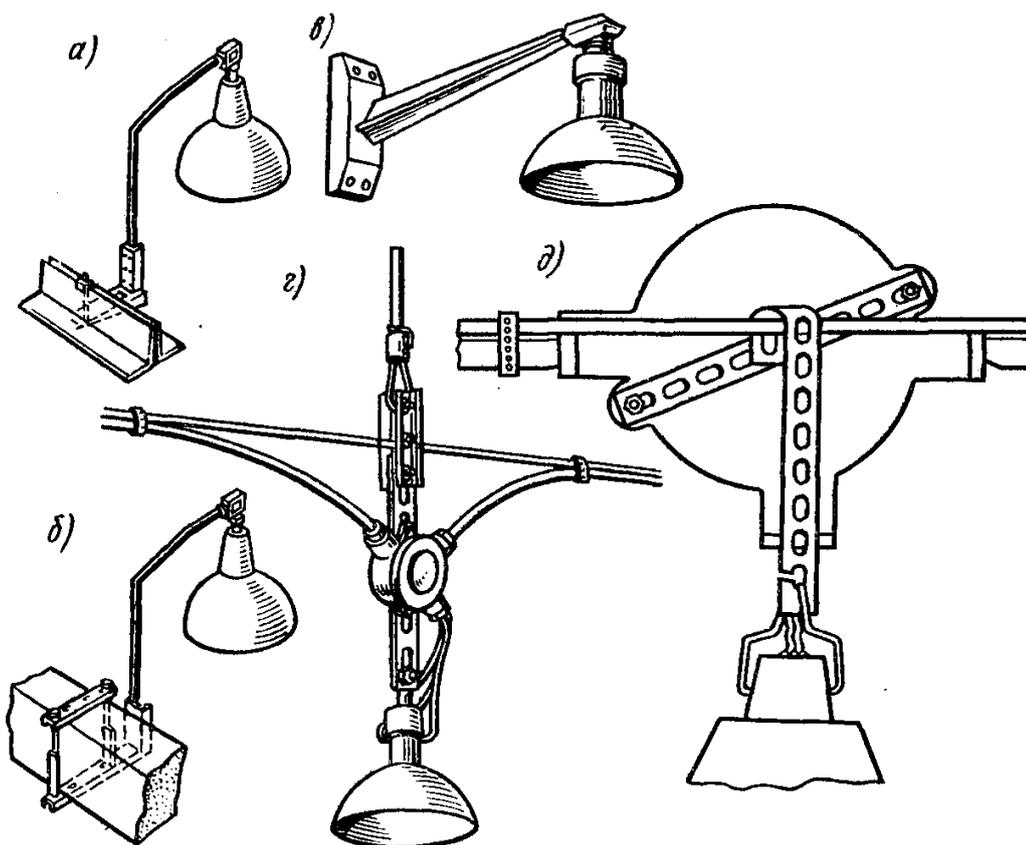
Варианты крепления светильников: *а* - на металлической ферме; *б* - на железобетонной ферме; *в* - на стене; *г* - подвеска на тросе; *д* - на тросовой проводке
